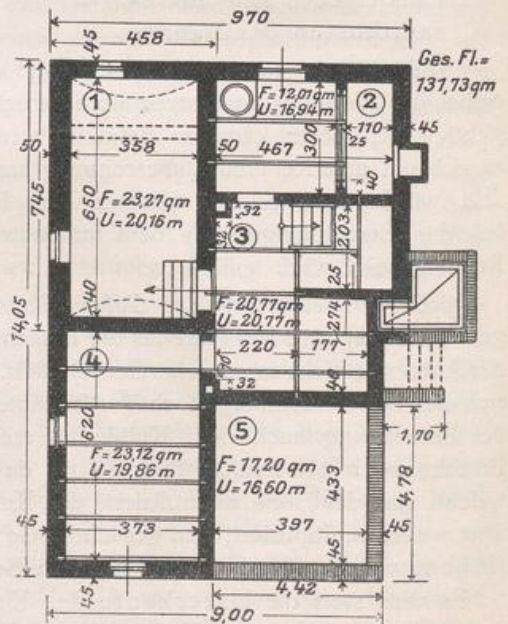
Grundriß des Kellers. M. 1 : 200.
